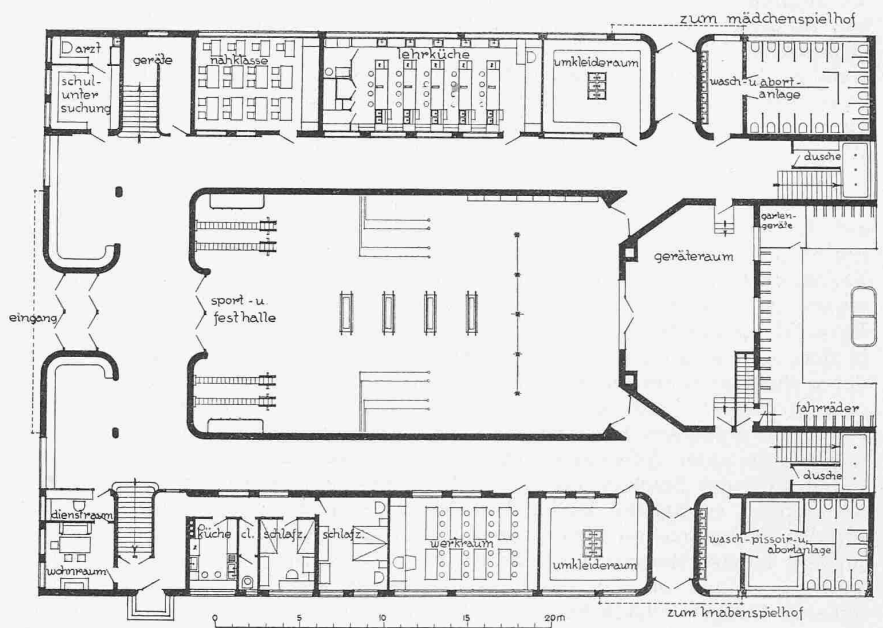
Erdgeschoss-Grundriss, 1:400. Orientierung: links Süd, rechts Nord.
